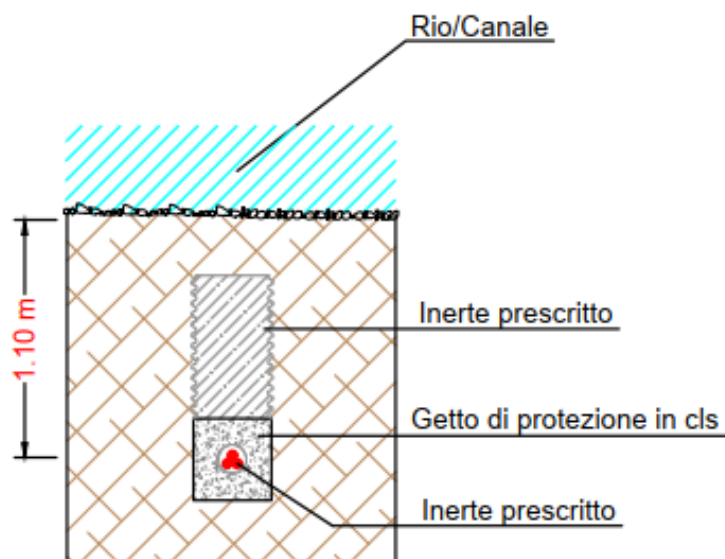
Sezioni tipo di posa cavidotto attraversamento rio/canale (da tav. PA-Tav.12.4)
